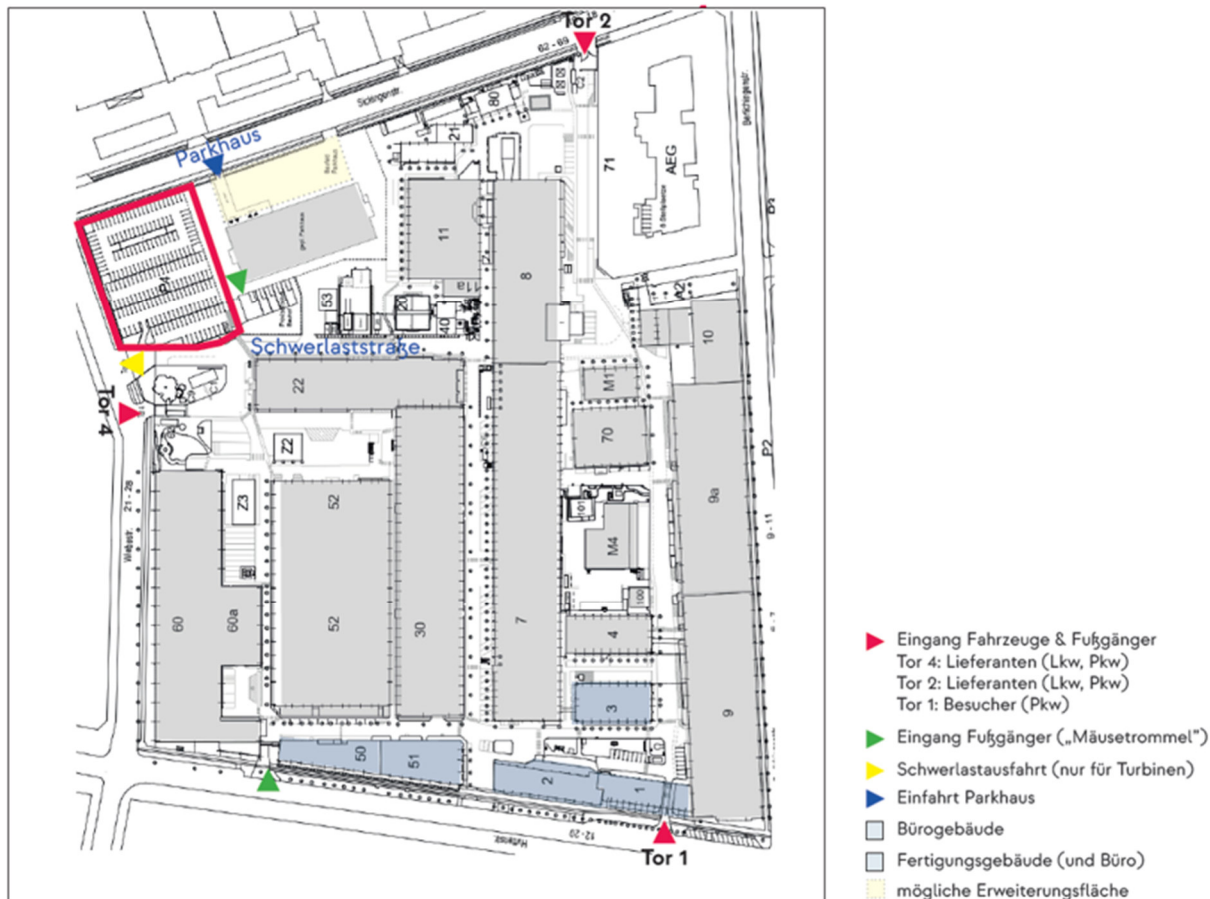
Werksgelände Siemens Energy, Gebäude- und Erschließungsplan
